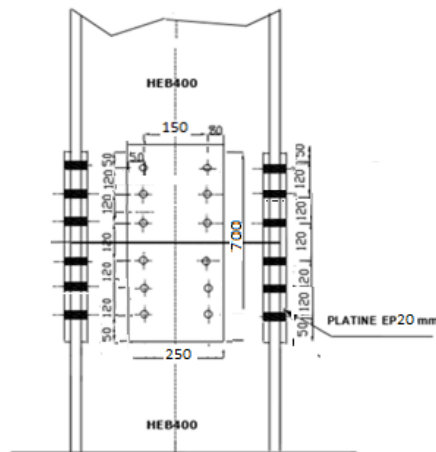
Assemblage poteaux – poteaux (HEB400- HEB400)
